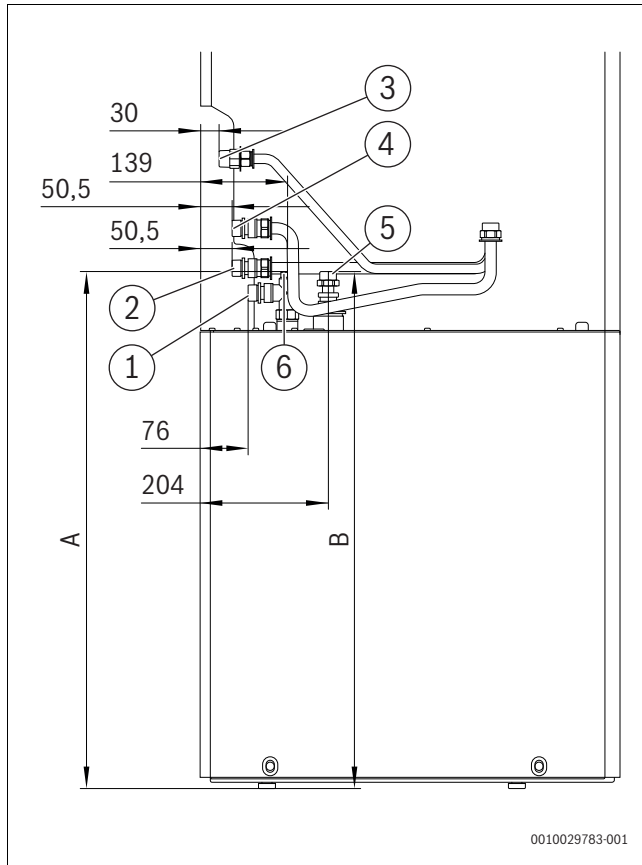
Aanzicht van de achterzijde (afmetingen in mm)
